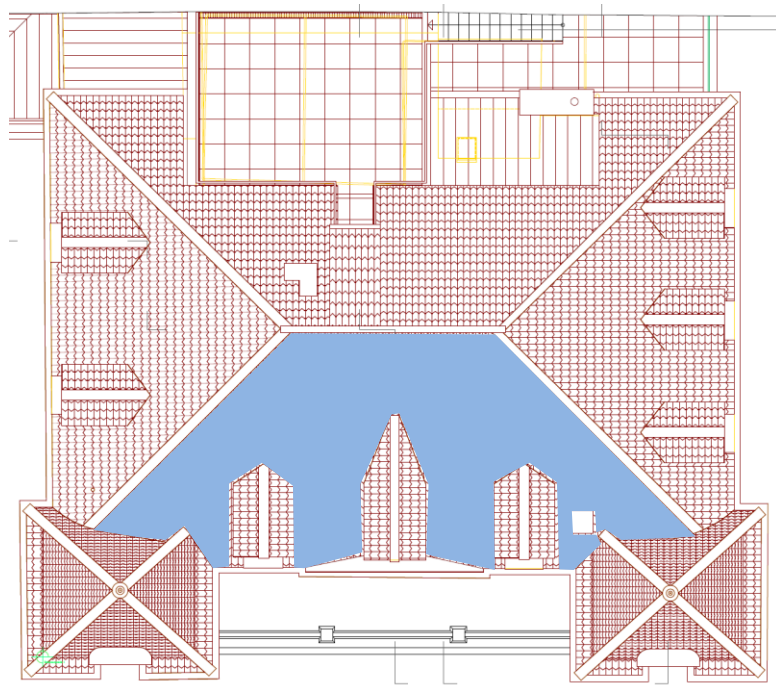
Dachaufsicht Villa, mögliche Dachfläche für PV-Module blau angelegt
